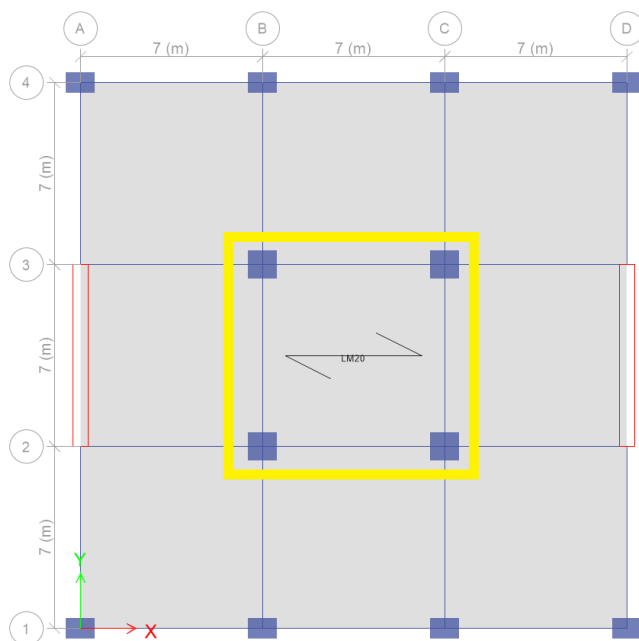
Indicación de las columnas que componen el “núcleo central”
